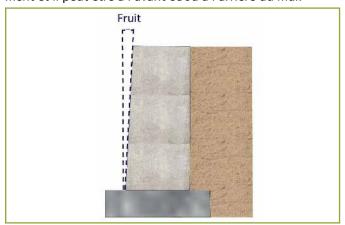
Schéma de principe illustrant le fruit d'un mur (Dessin de Cédric Houel)
